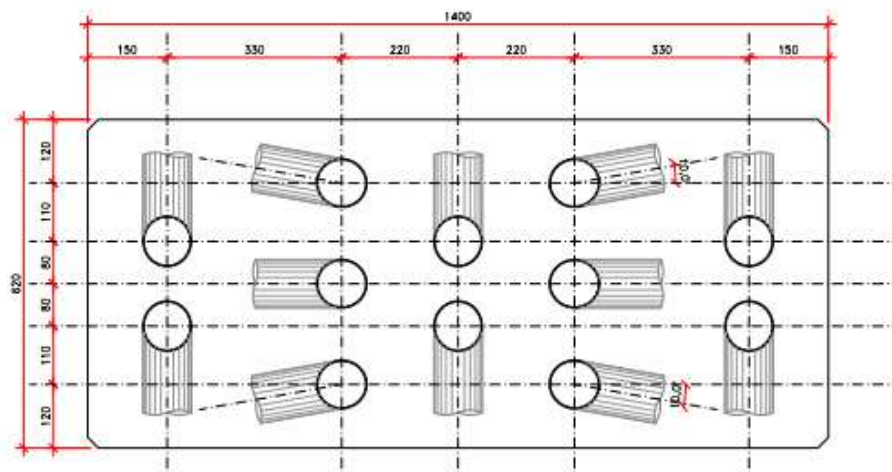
Dolfim de amarração (DAM) - Estaqueamento
